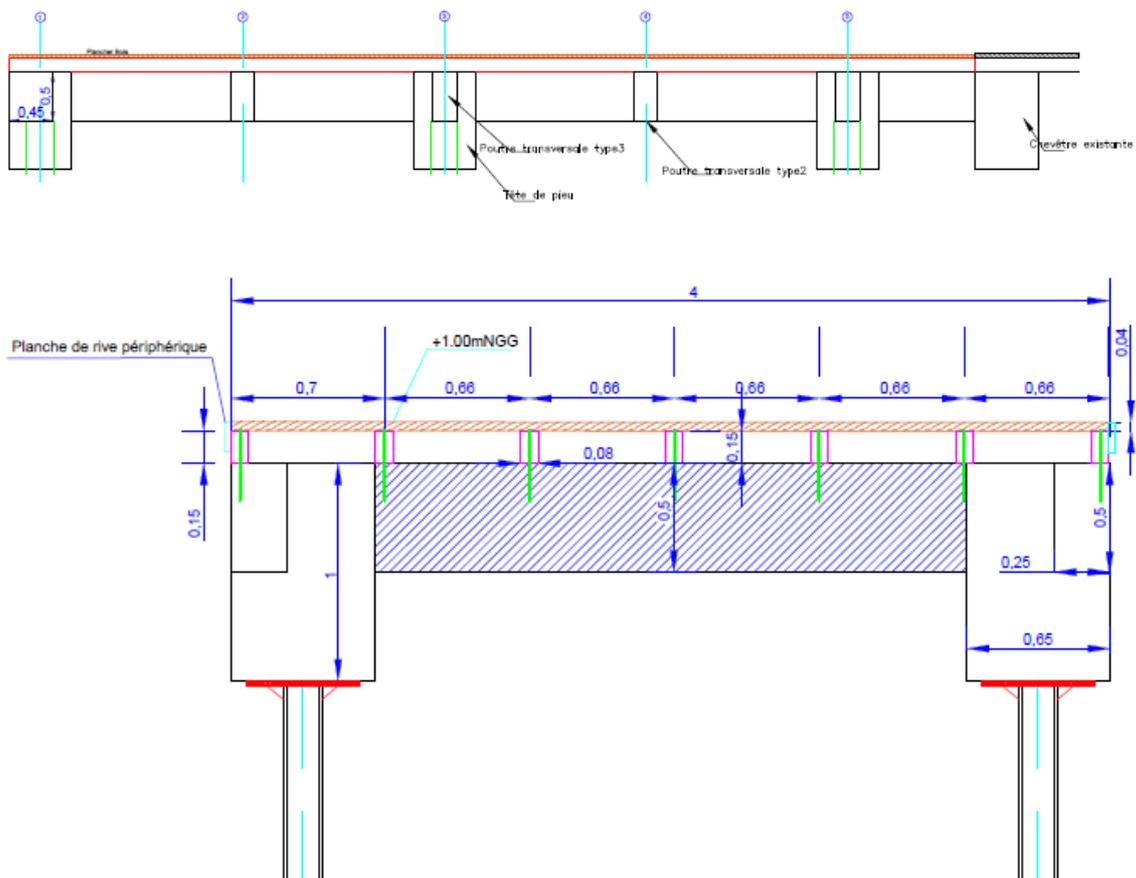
Coupe longitudinale et transversale du ponton (source : PRO/DCE Suez Consulting, décembre 2020)
